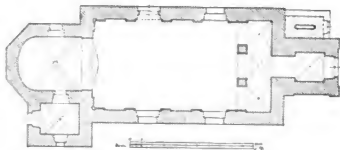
Borotitz. Grundriss der Kirche.
